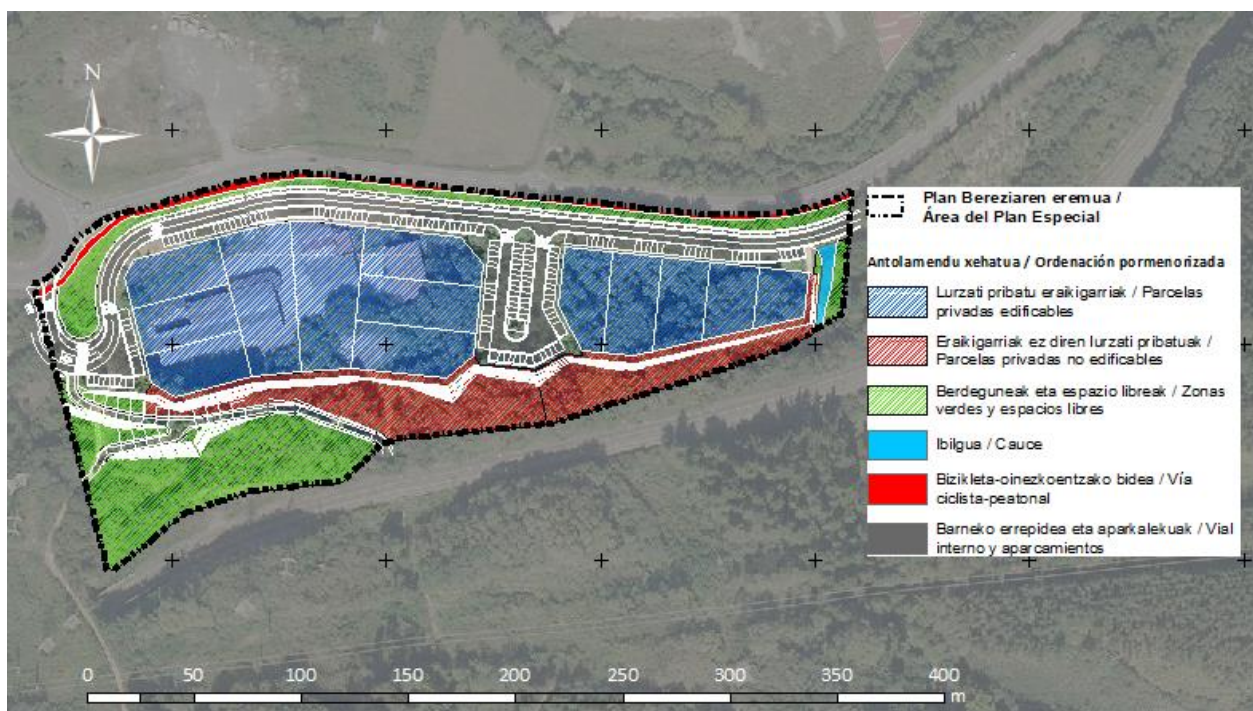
Zonificación pormenorizada sobre ortofoto. Fuente: Plan Especial. Plano O-03 Zonificación pormenorizada. Elaboración: Ekolur
